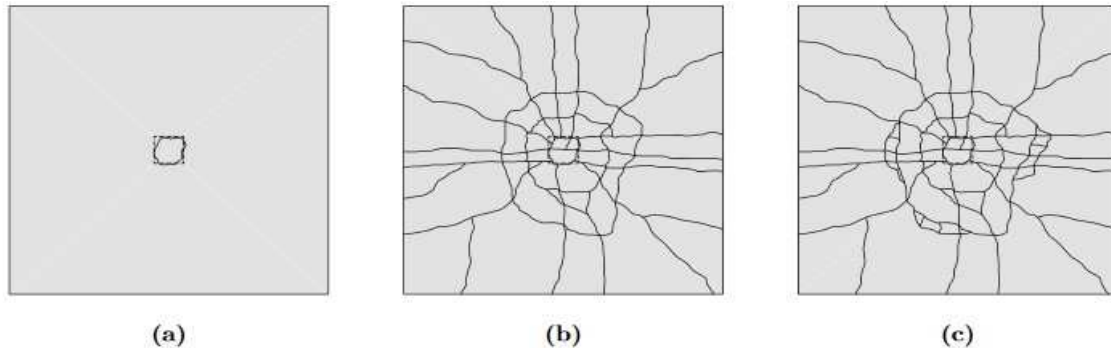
Evolution des fissures sur la face tendue d'une dalle pendant la mise en charge
